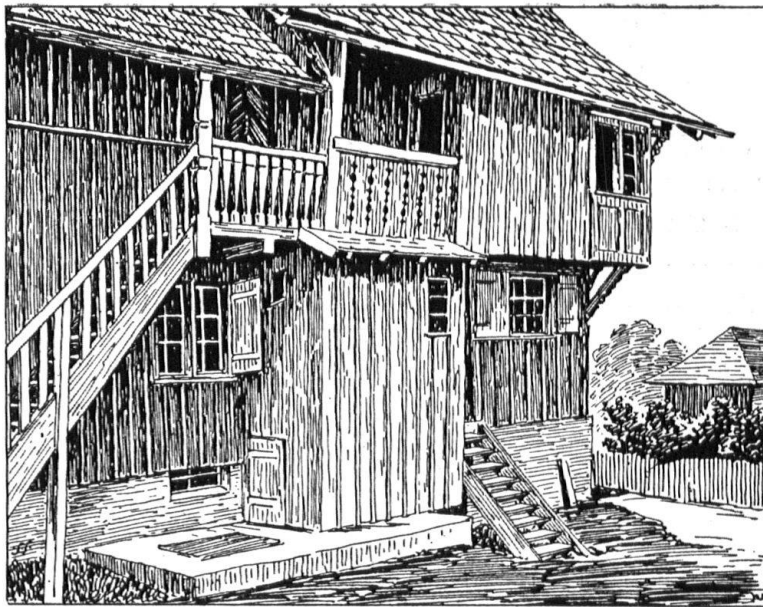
Partie aus Häggenschwil (Kanton St. Gallen). Holzkonstruktion mit Leistenschirm. — Fig. 2. Maisons à Häggenschwil, canton de St-Gall. Construction en bois. Parois en planches, avec listes protectrices.
